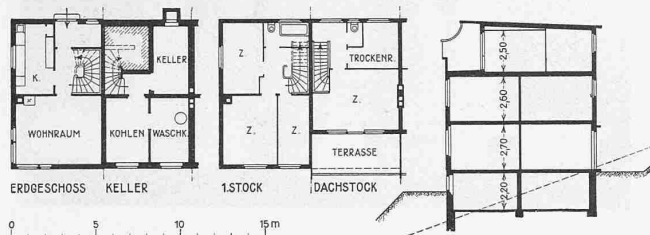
Grundrisse und Schnitt. — Masstab 1:400.
